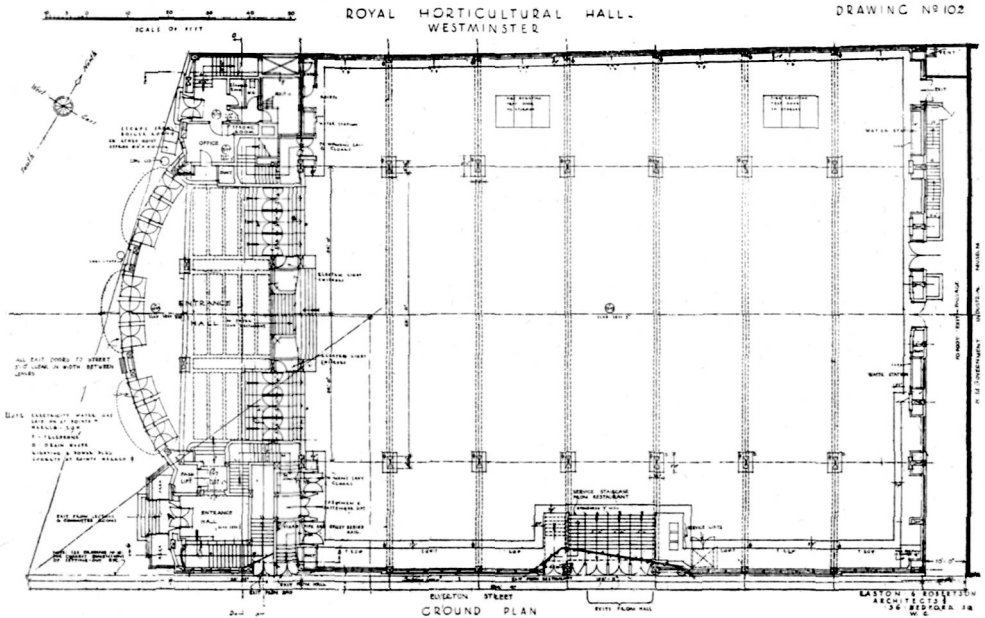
Royal Horticultural Hall zu London. Erdgeschoß-Grundriß
